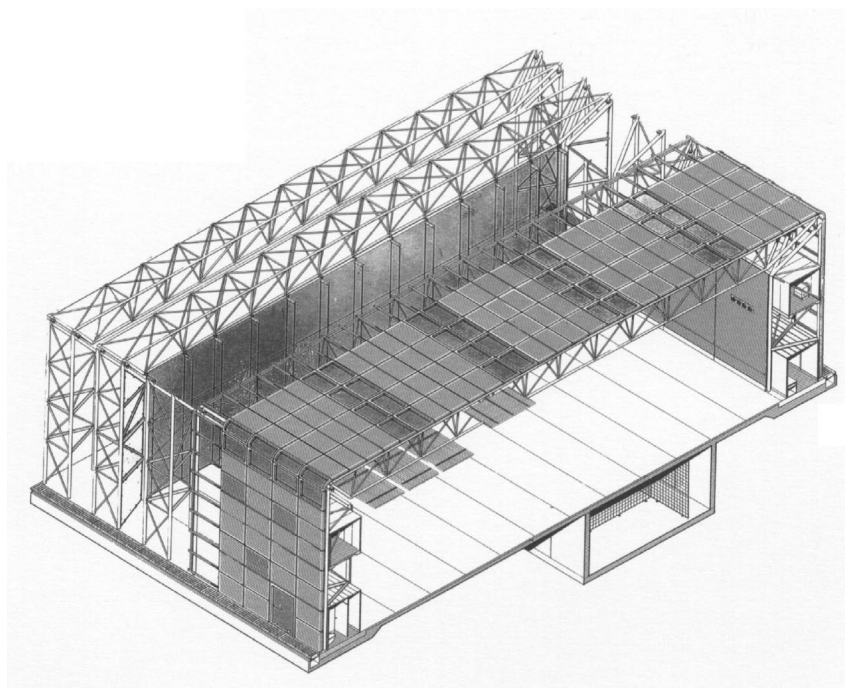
Centro Sainsbury: sistema estrutural
